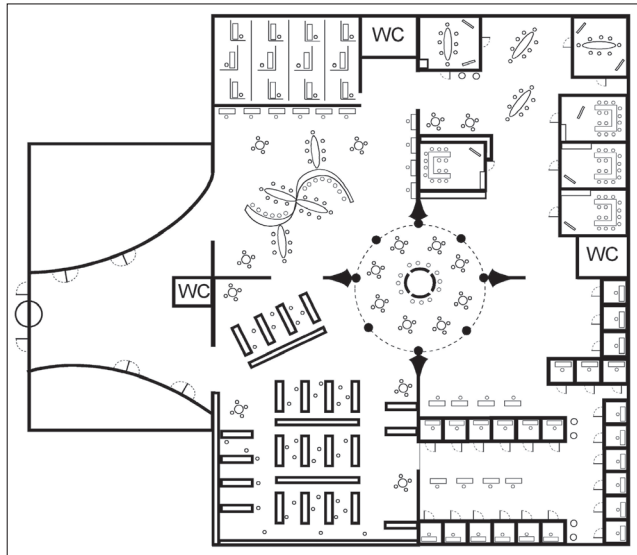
Grundriss mit verschiedenen „Zonen“ (Entwurf von Sandra Lechelt und Nadine Hoehle [44])
